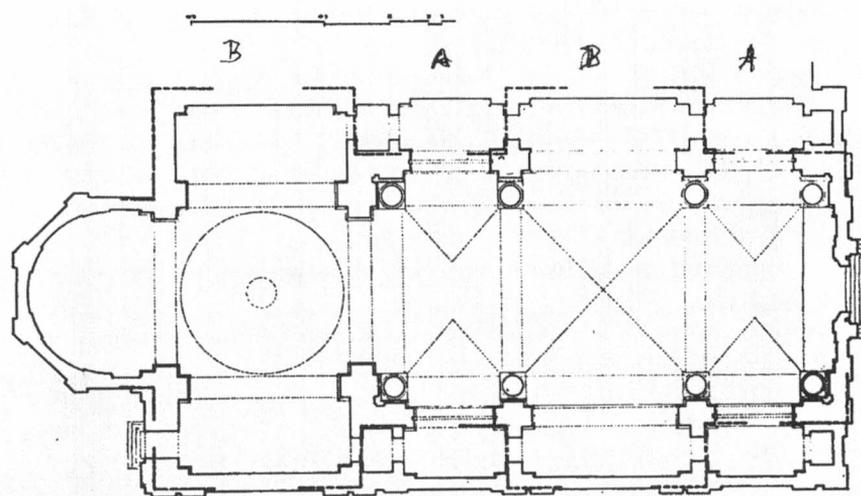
BOLOGNA, S. Salvatore. Planimetria (G.A. Mazenta)
